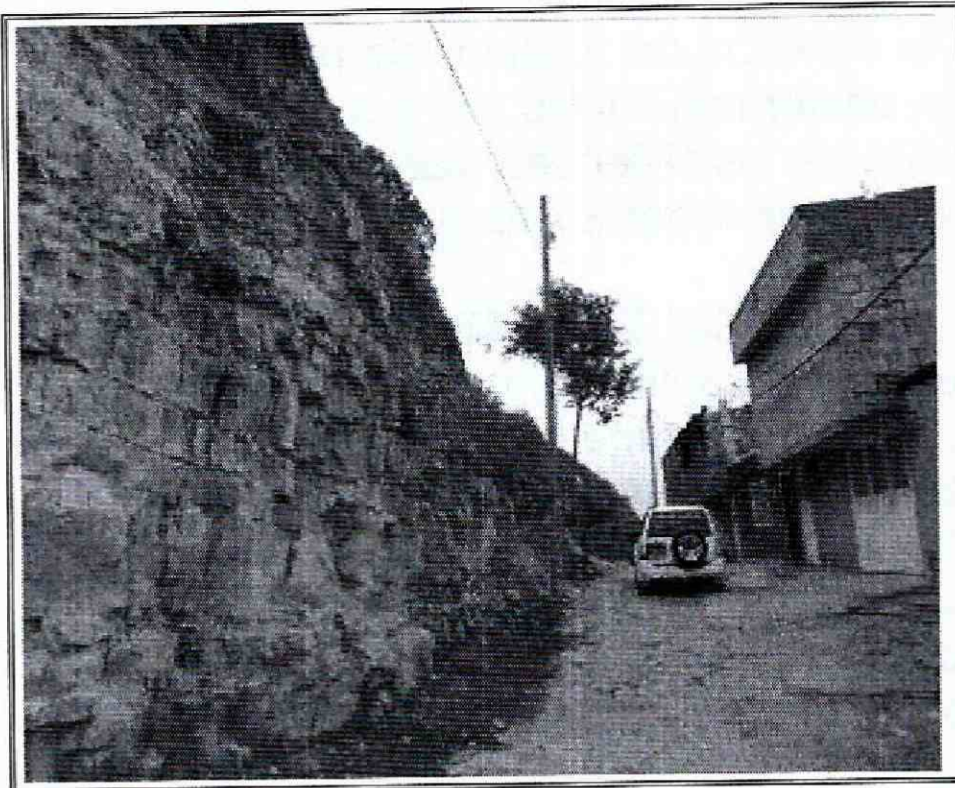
Vista via de acceso al predio de la Transversal 20 D Bis A No. 68 K - 36 Sur
